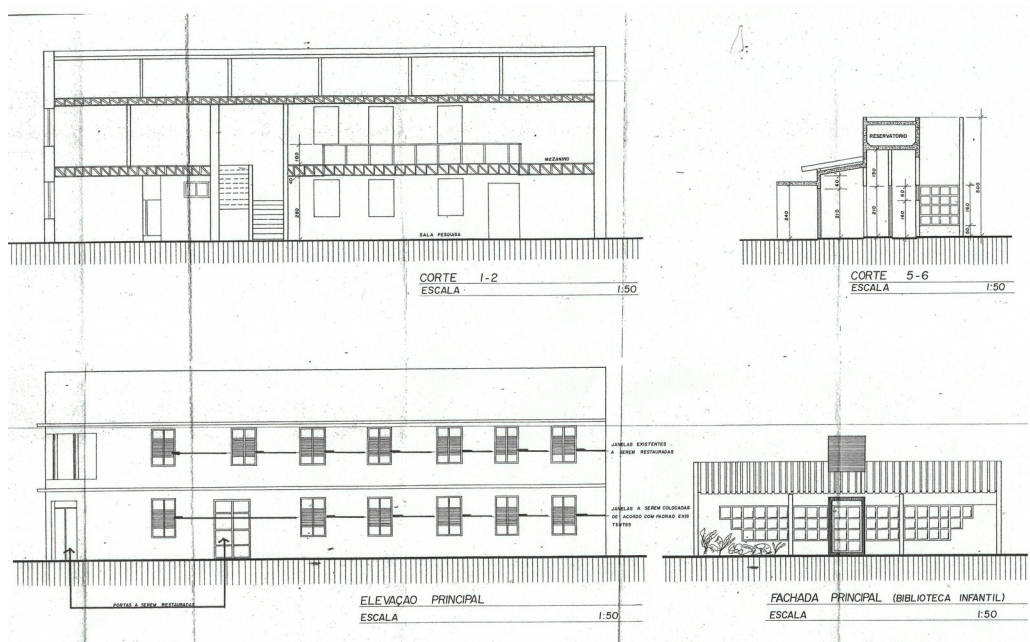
Corte e Fachada Leste pela Av. Geraldo Ney e proposta de uma biblioteca infantil ao fundo do lote do Palace Hotel de Campinas. Fonte: Arquiteto Nagib Rahime.
